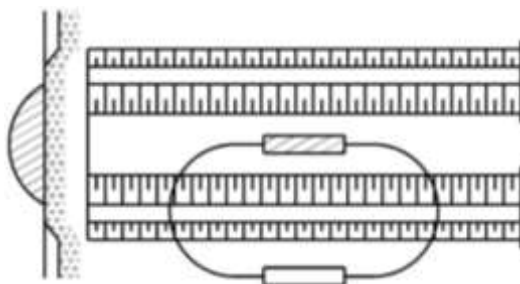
Разработка грунта скрепером при кольцевой продольной схеме
